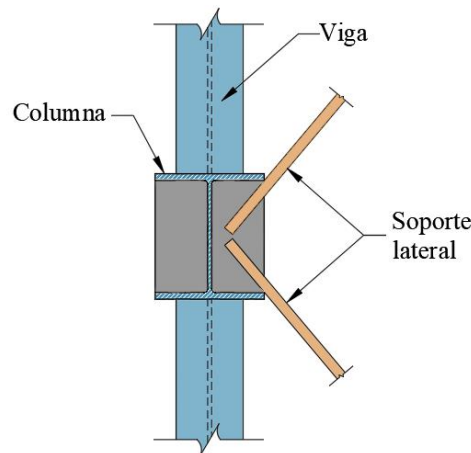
Soporte lateral de la unión viga columna
